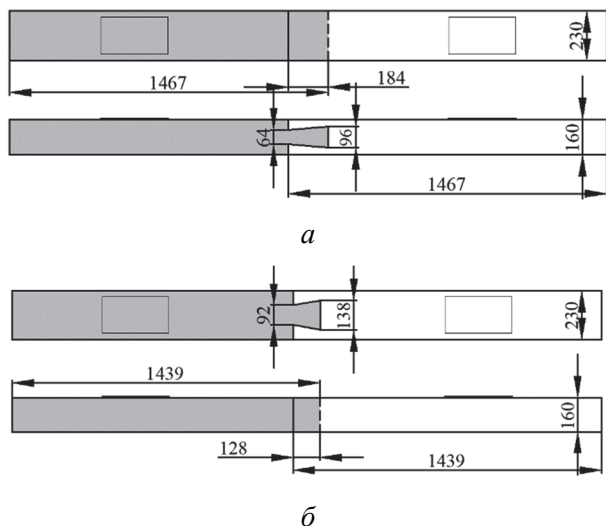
Конструктивная схема составной шпалы с одним соединением «ласточкин хвост»: а – с горизонтальным расположением шипа; б – с вертикальным расположением шипа
